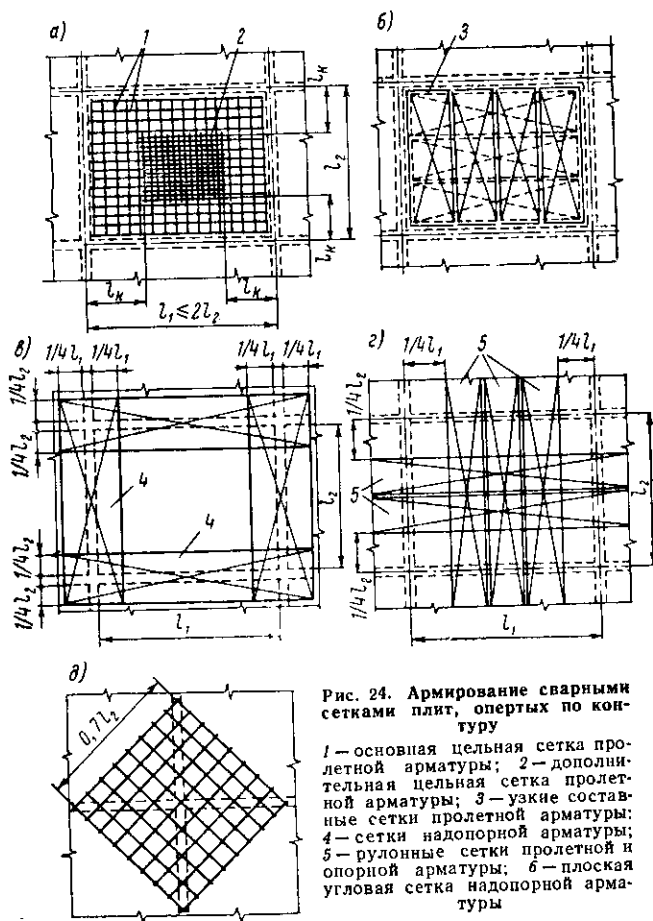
Армирование сварными сетками плит, опертых по контуру
